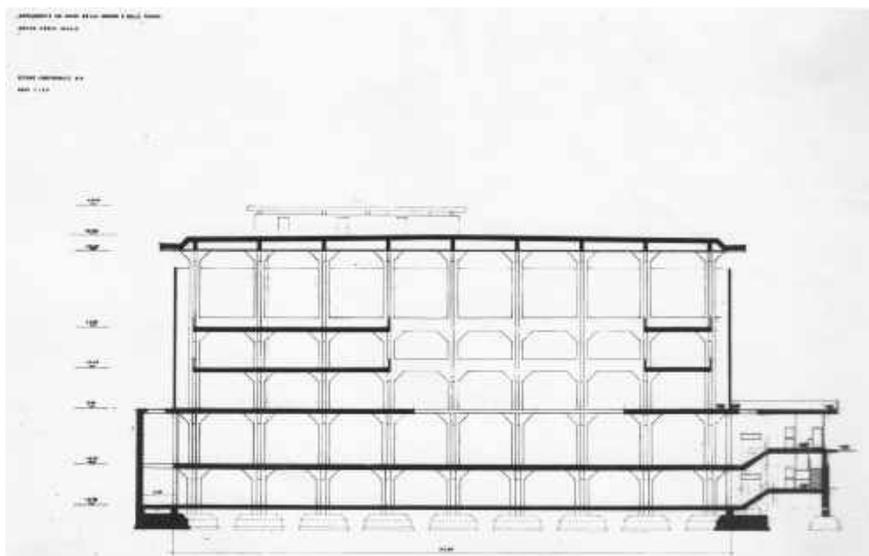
Padiglione Aeronavale, sezione longitudinale, seconda soluzione
